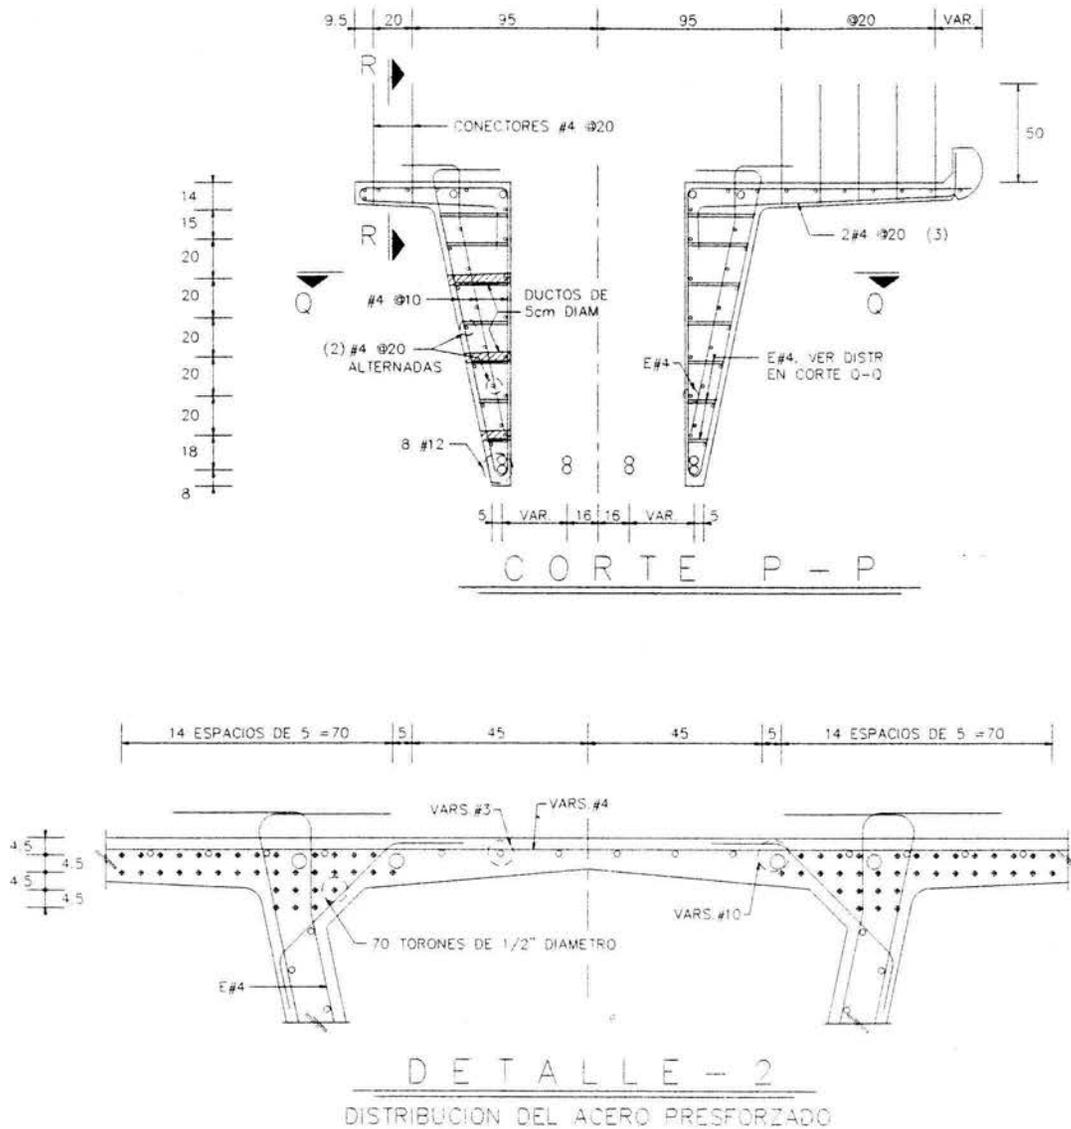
Detalle de refuerzo de trabe de apoyo
